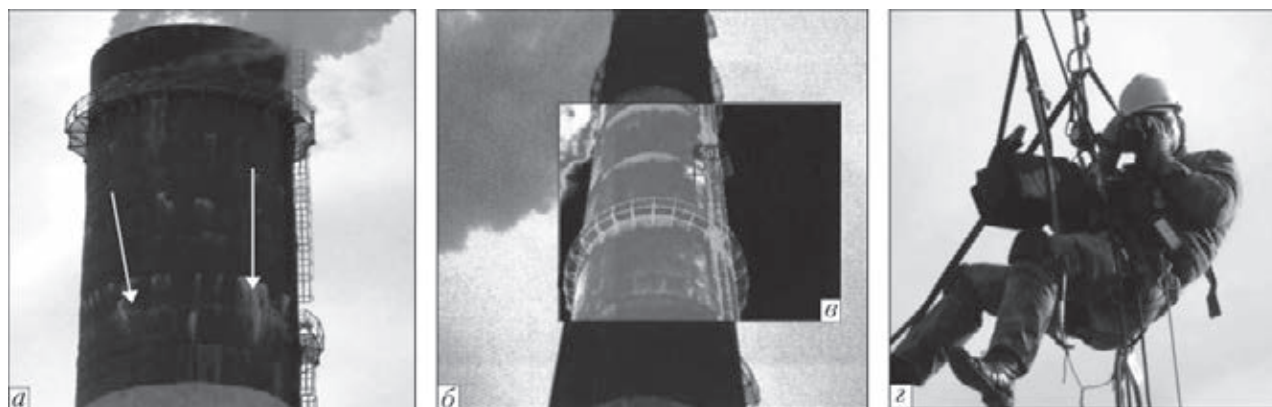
Дефекты и повреждения наружной поверхности железобетонной дымовой трубы высотой 180 м: образование наледей (обозначены стрелками) вокруг некачественно выполненных рабочих швов бетонирования с отметкой +145 м до отметки +180 м (а); определение мест протечек и образования конденсата с помощью тепловизионного метода контроля (б); термограмма (в) – на ИК-изображении зафиксированы участки повышенных теплотерь через ограждающие конструкции. Зоны дефектных (с пустотами и полостями) участков рабочих швов трубы соответствуют по высоте трещинам во внутренней футеровке (рис. 6), что приводит к конденсации влаги и последующей морозной деструкции бетона; применение метода промышленного альпинизма при обследовании ствола трубы (г)
